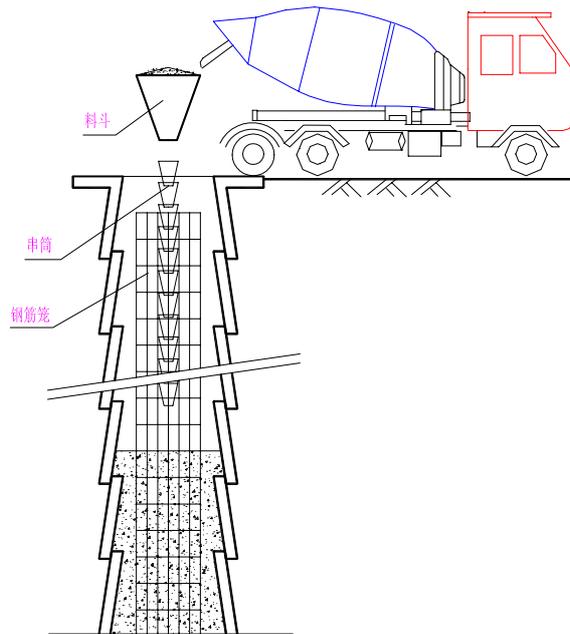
人工挖孔桩混凝土串筒灌注示意图
